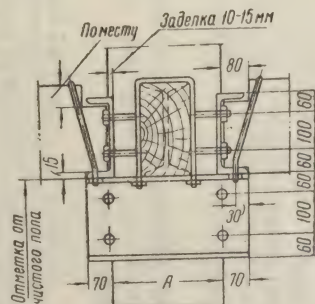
Типы металлических консолей к железобетонным колоннам каркаса подвесных путей:
